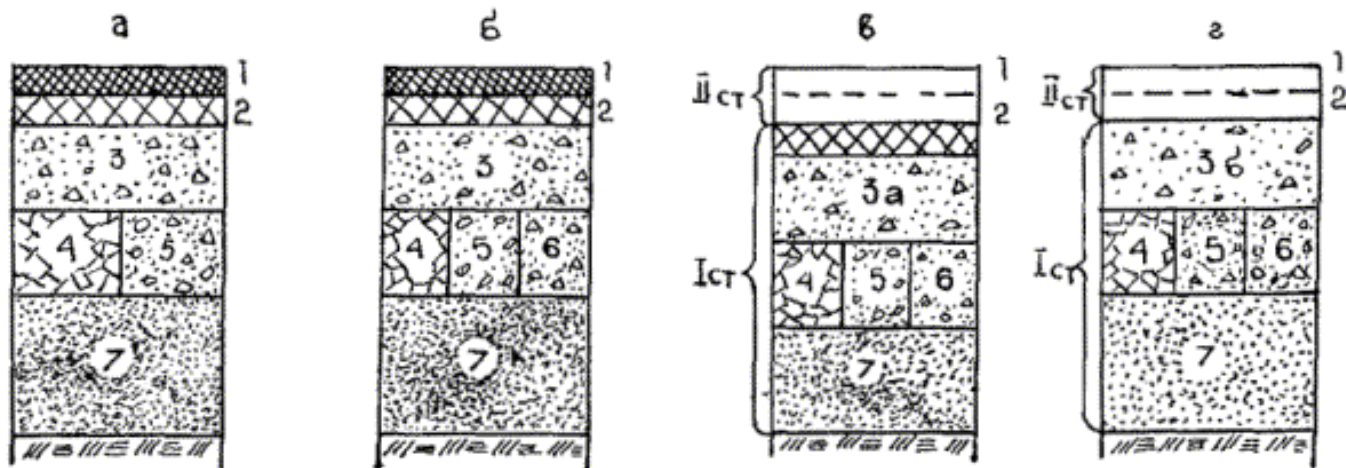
Принципиальные схемы конструкций дорожных одежд с асфальтобетонными покрытиями и основаниями из укатываемых бетонных смесей:
